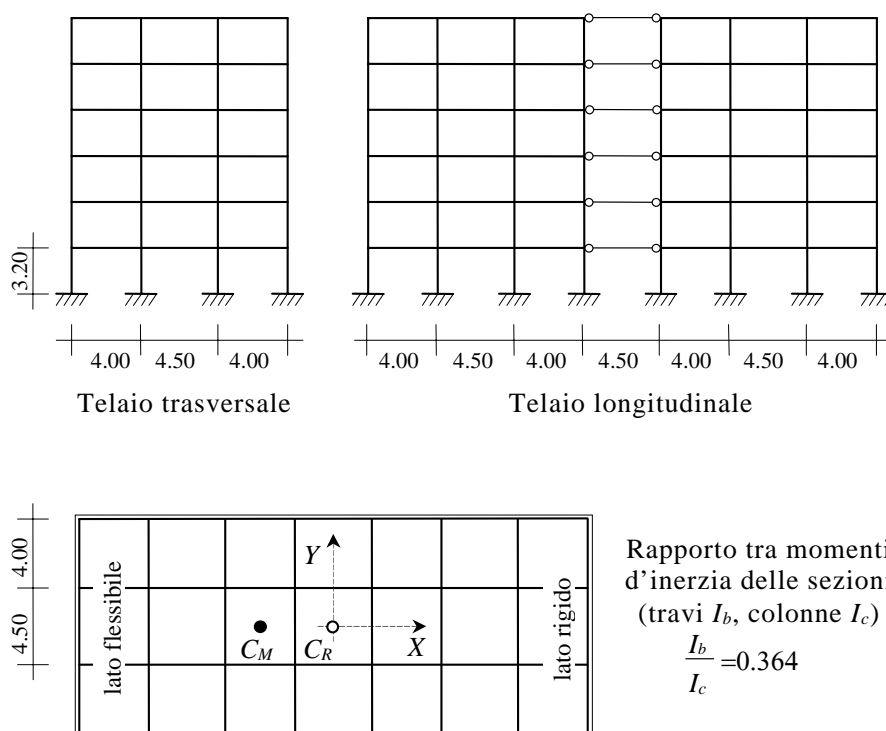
Pianta del sistema multipiano e schema dei telai.
